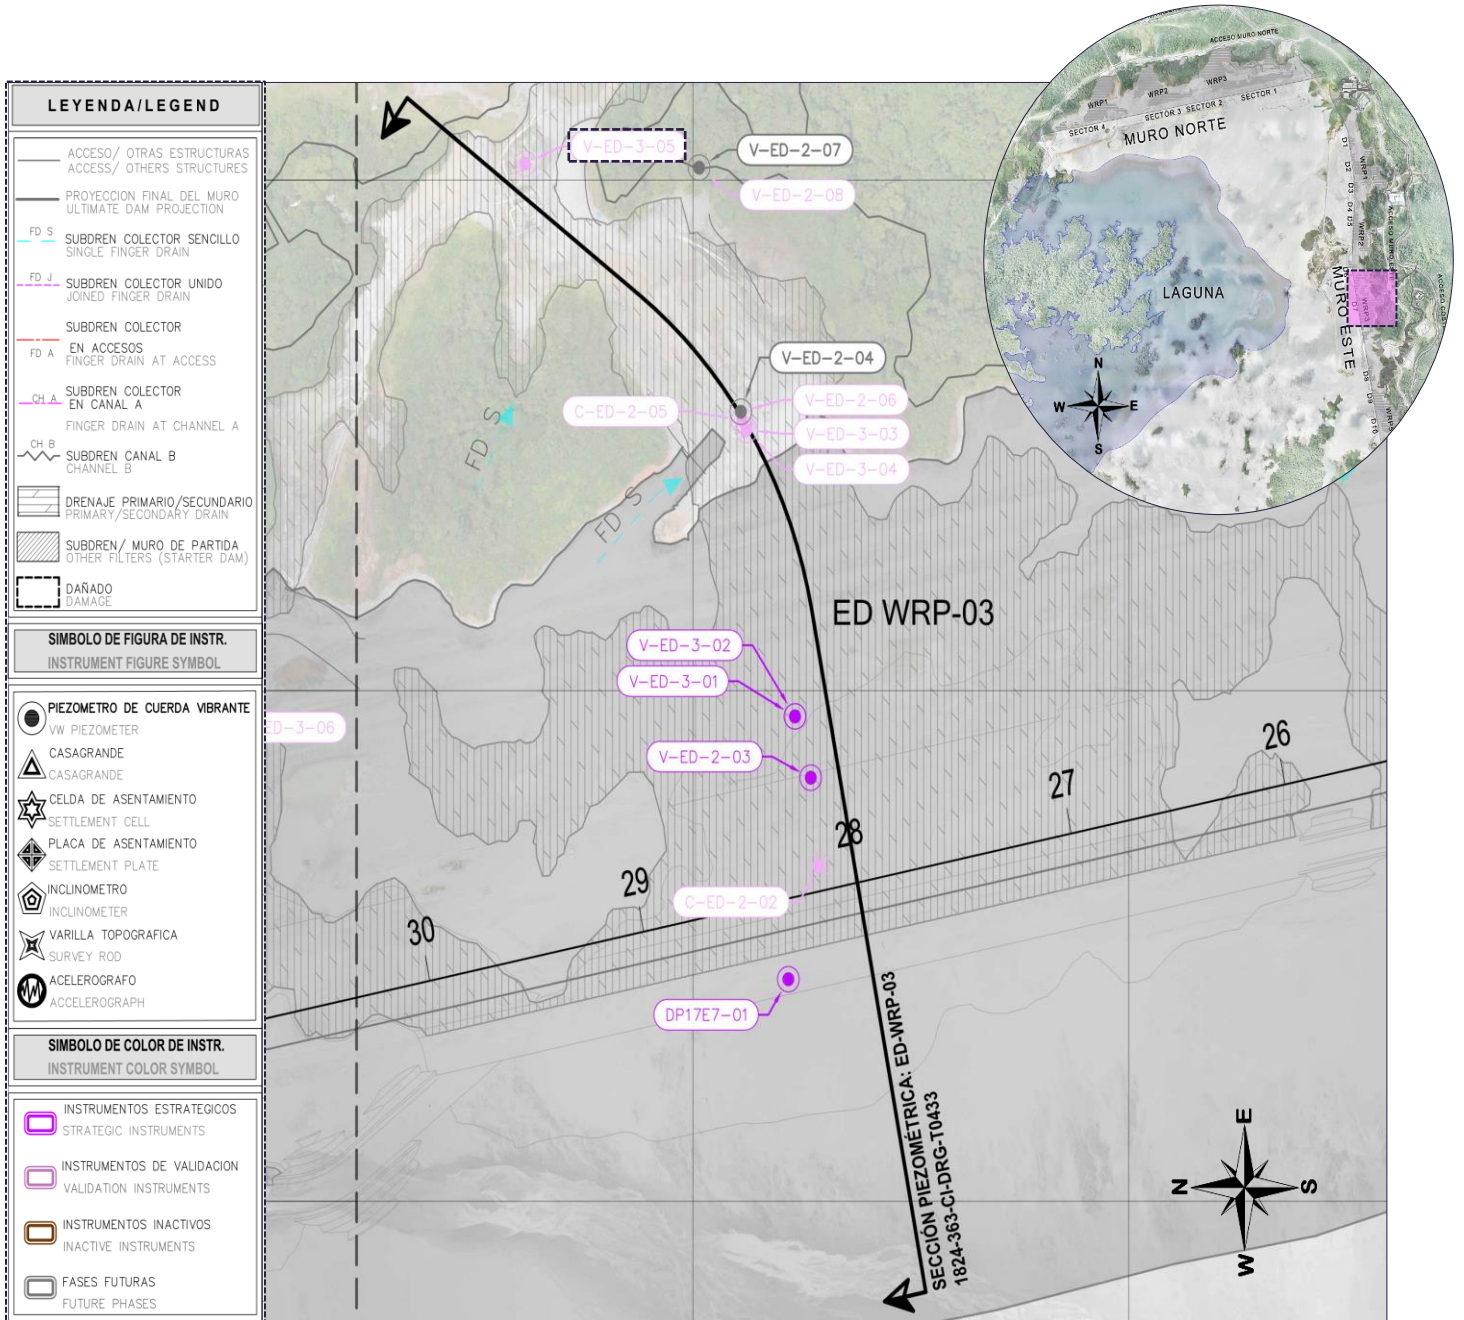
Vista de Planta en el Muro Este WRP3 con Piezómetros
